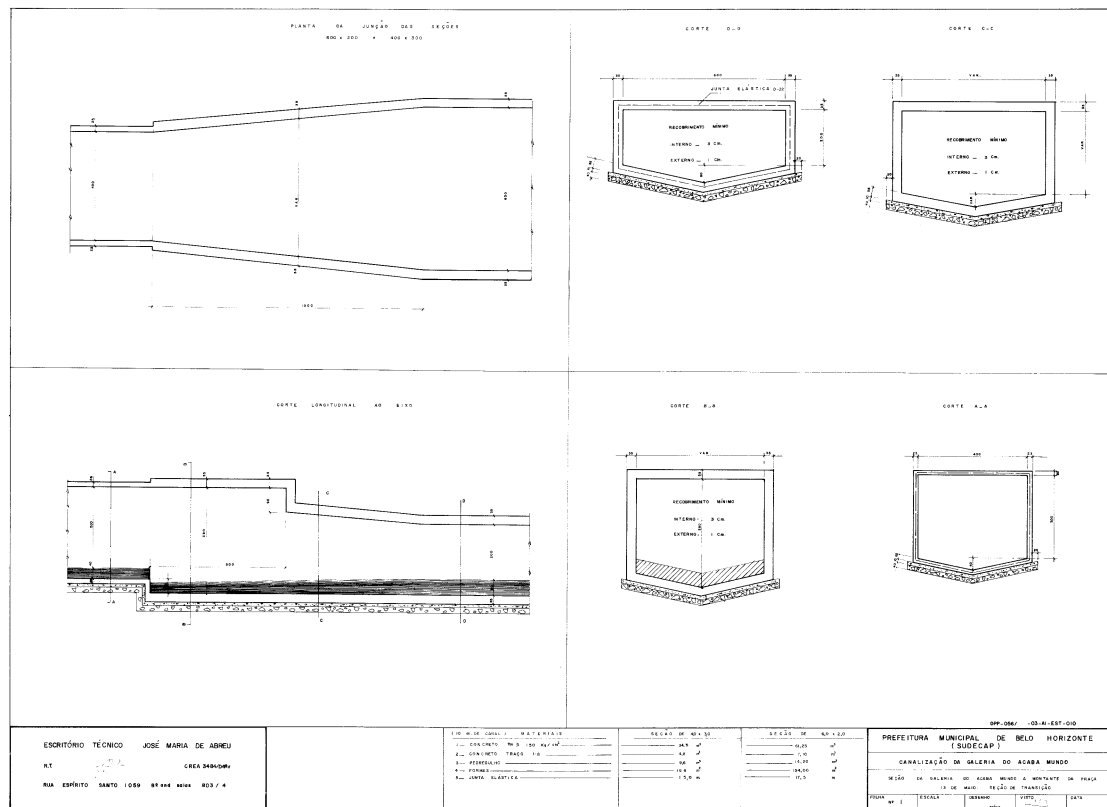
Projeto da canalização da galeria do Acaba Mundo. Seção da galeria do Acaba Mundo a montante da Praça 13 de Maio (atual Doutor Lucas Machado). Seção de transição com a galeria do Córrego da Serra.
